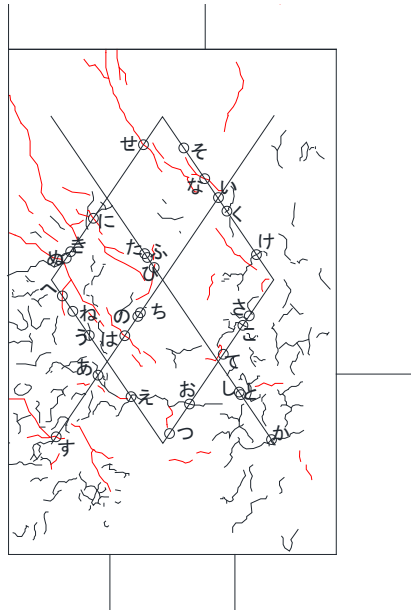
パイルキャップひび割れ幅測定位置(試験体 C-3 負荷荷)
